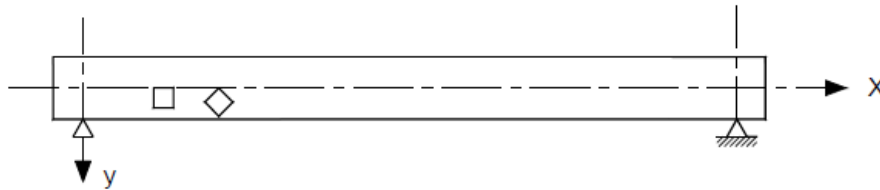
Vista longitudinal da viga com representação de dois elementos infinitesimais
